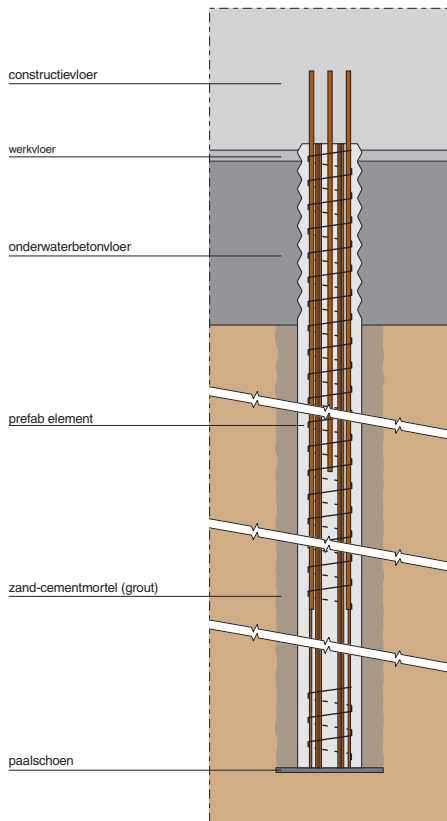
Randvoorwaarden wapening (volgens BRL - 2352)
